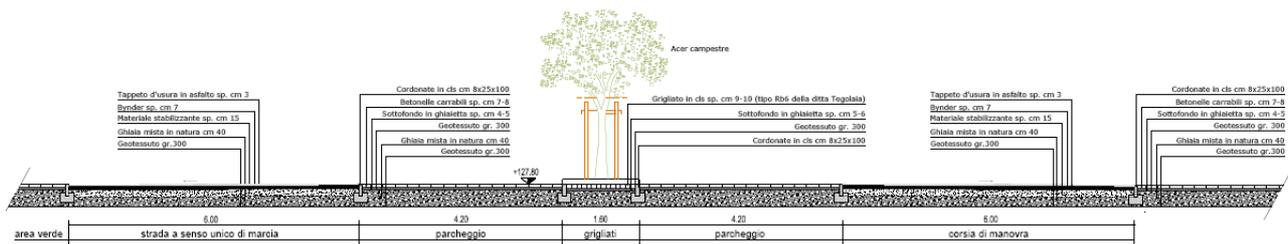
Sezione tipo degli stalli di parcheggio (Variante approvata - Tavola 6)
